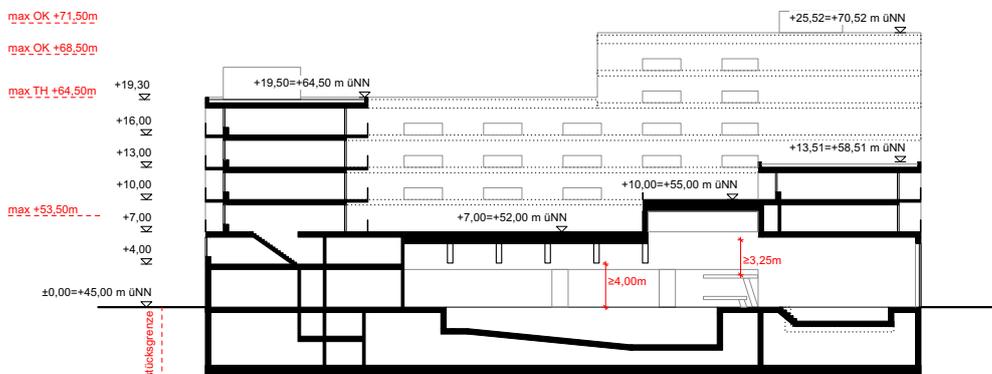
Schnitt und Grundriss Variante 3, o.M
